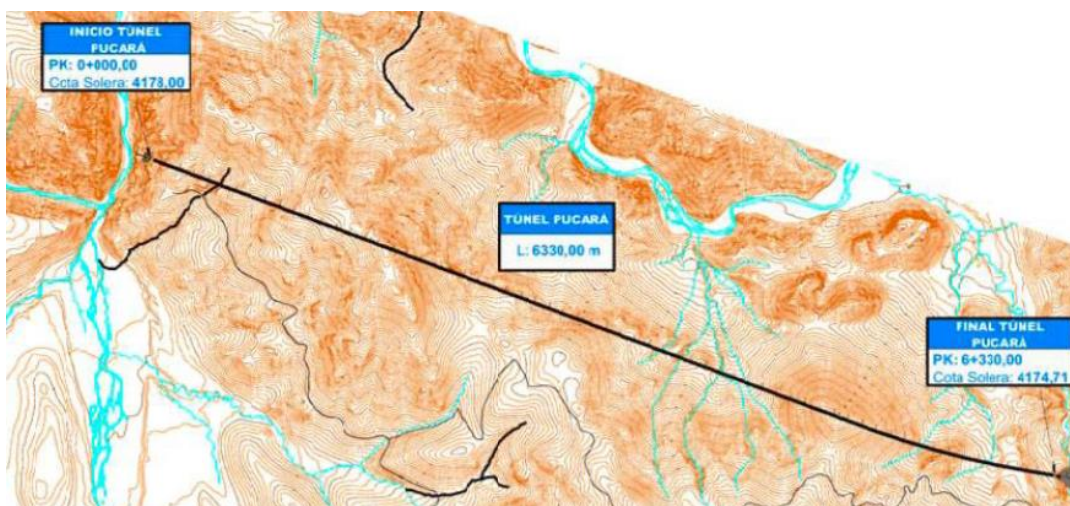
Trazado en planta túnel Pucará (Fuente: Expediente Técnico Final)
